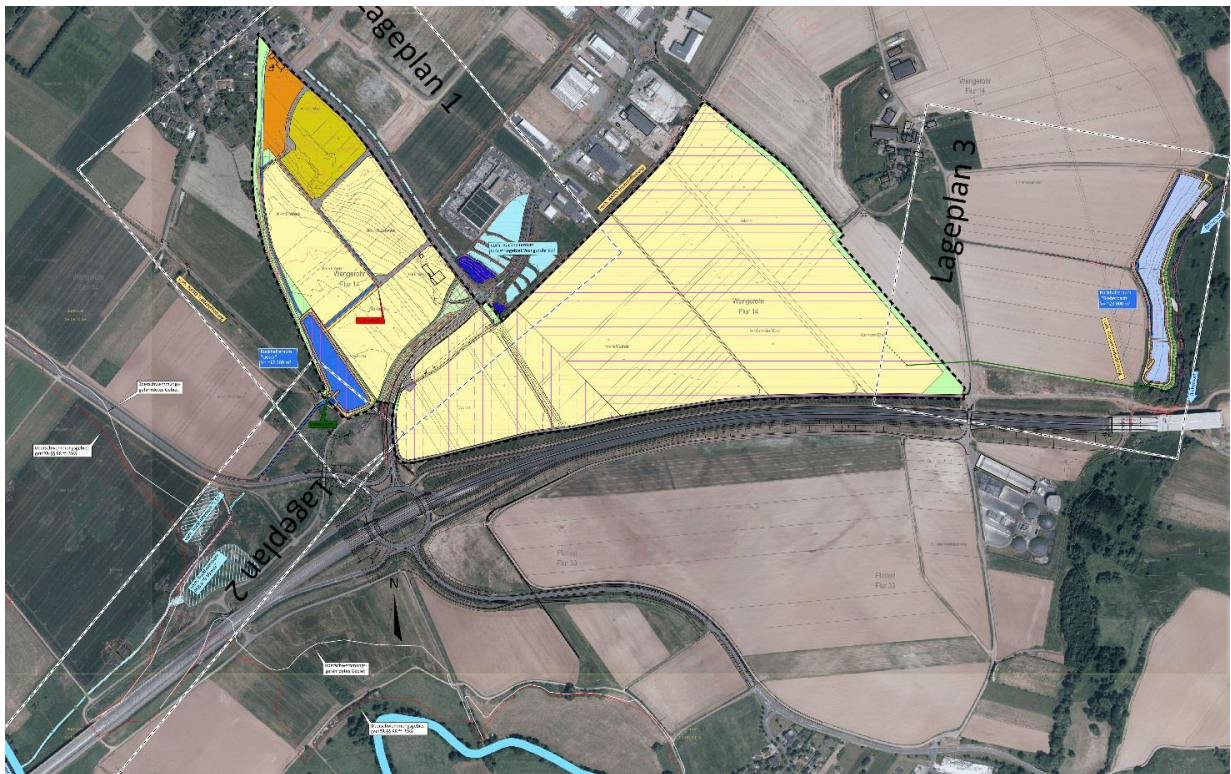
Übersichtslageplan zur Entwässerung - Ausschnitt
